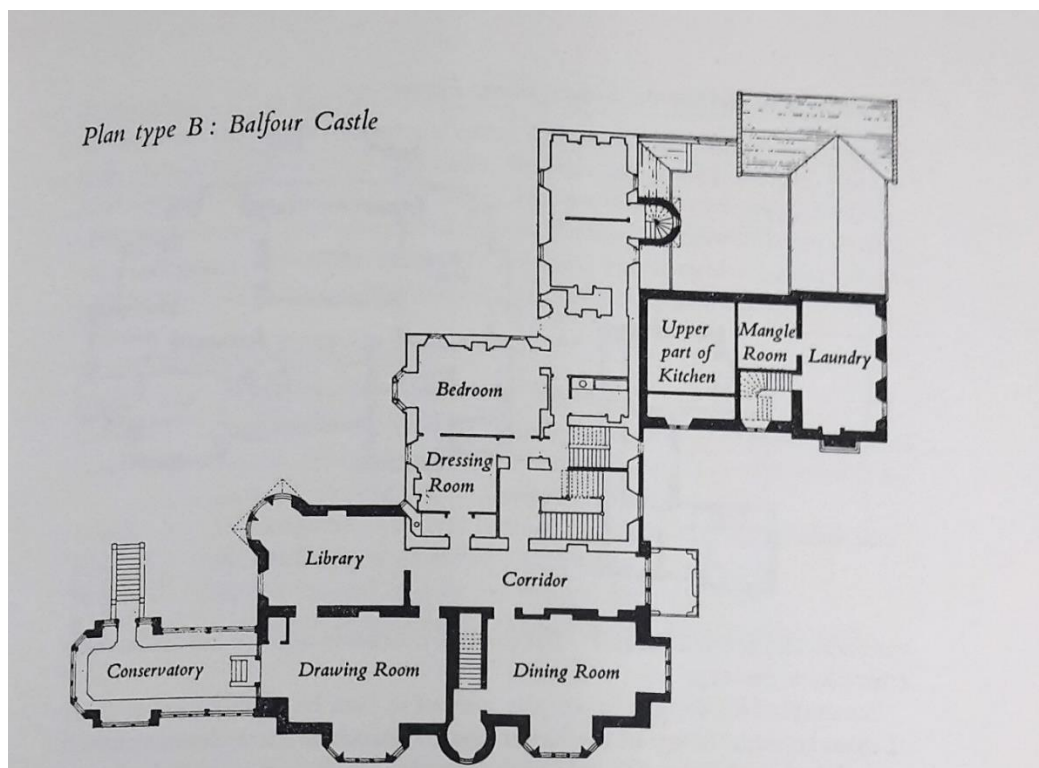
Plan de type B conçu par Bryce : Balfour Castle.
